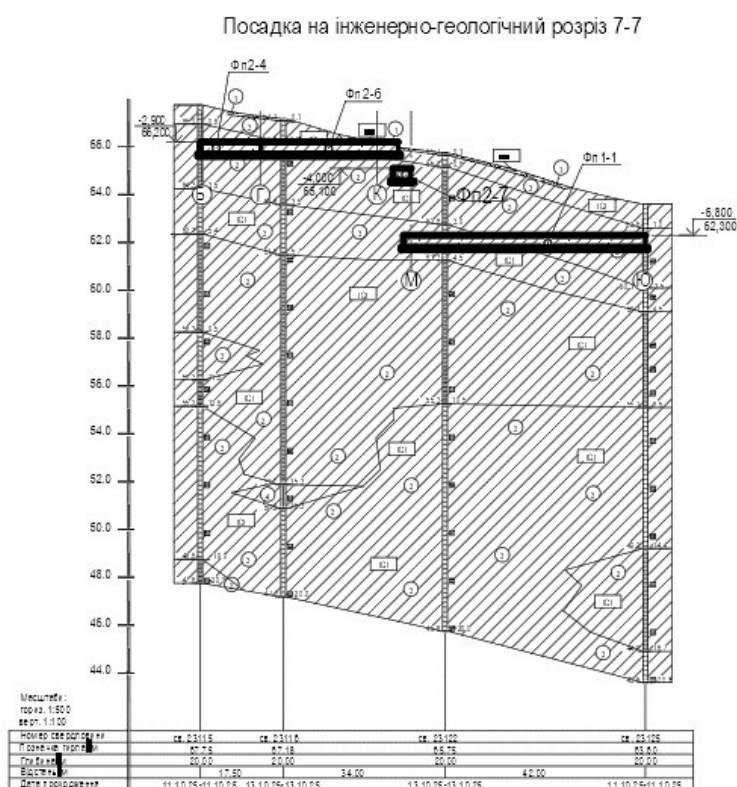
Посадка фундаментів будівлі школи на інженерно-геологічний переріз
